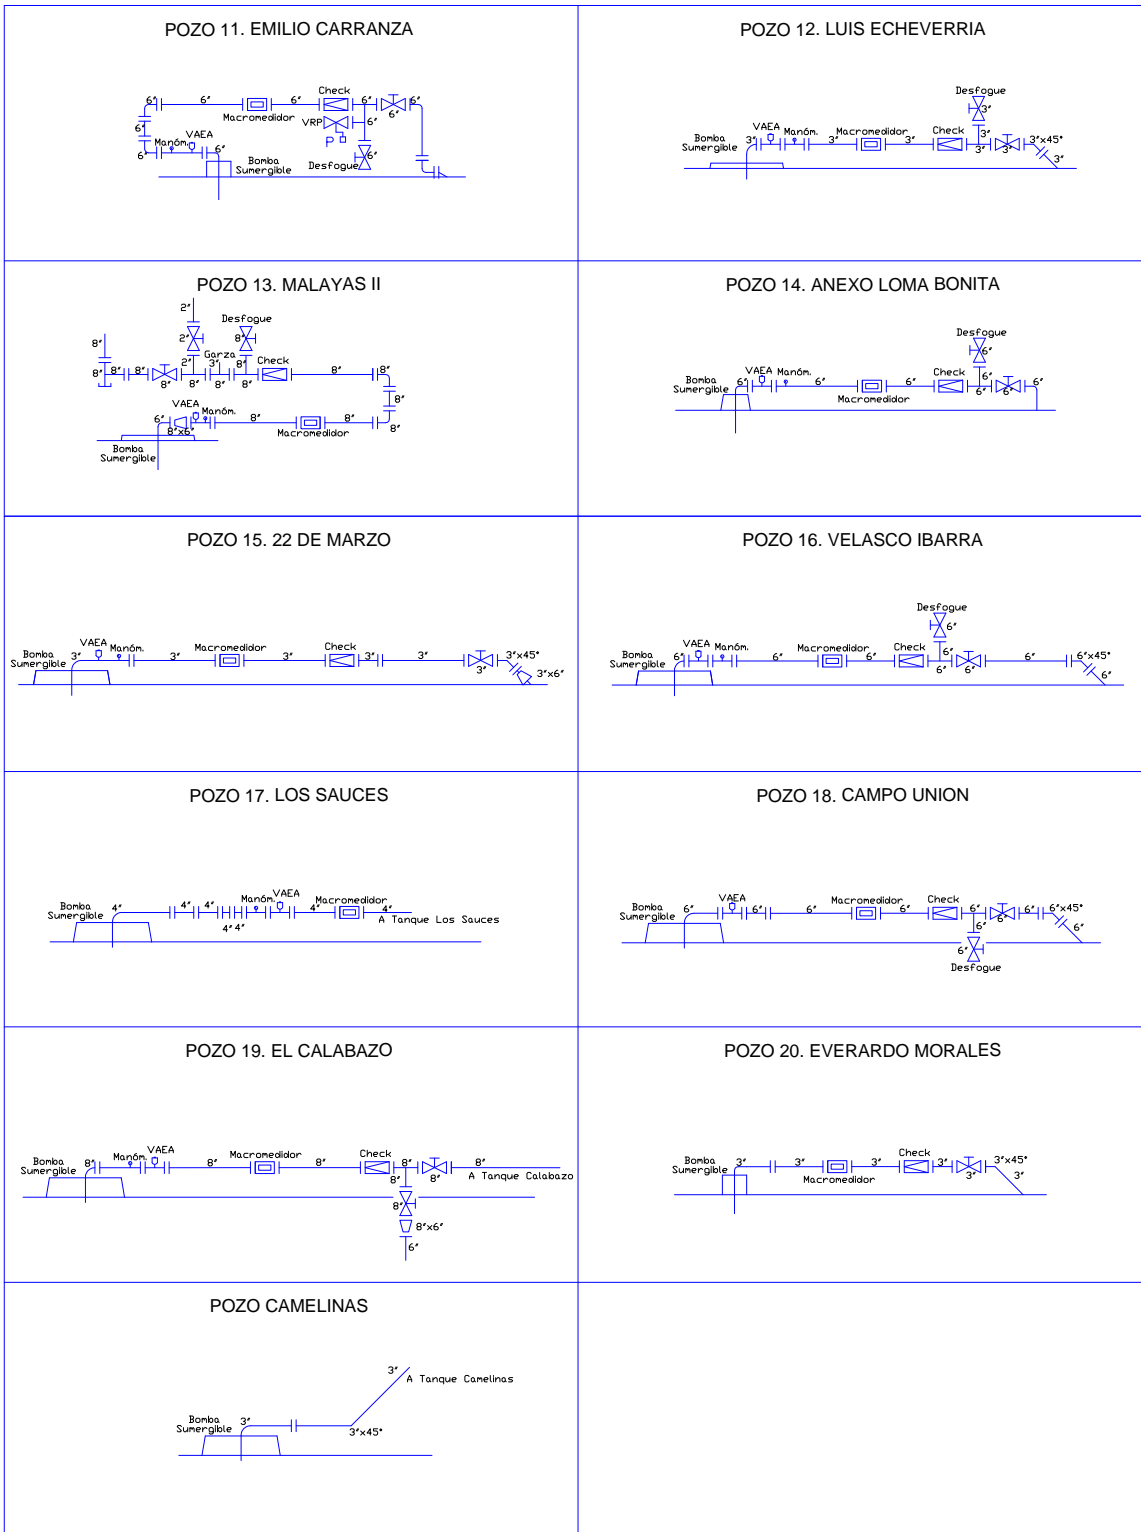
Detalles de fontanería de las captaciones en Acámbaro
